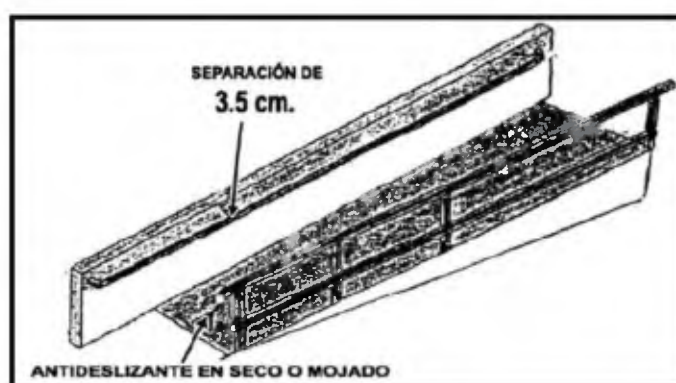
Separación de antideslizante en seco o mojado (Fuente: CONADIS)
